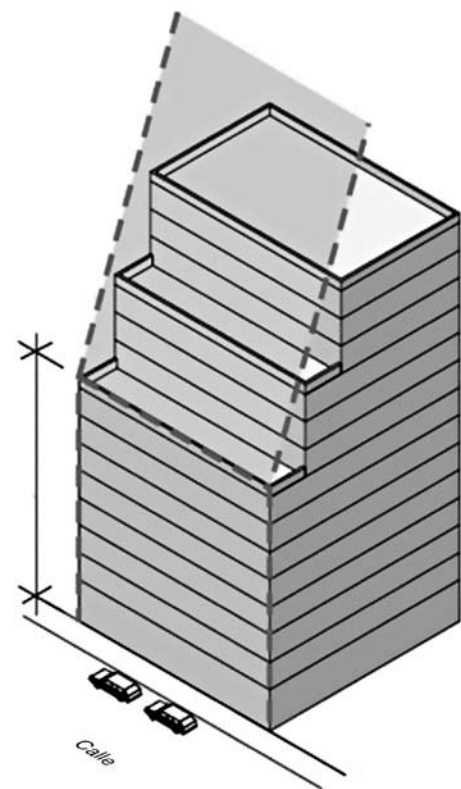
Plano de exposición al cielo. Fuente: New York City. Department of City Planning. NYC Zoning Glossary.
